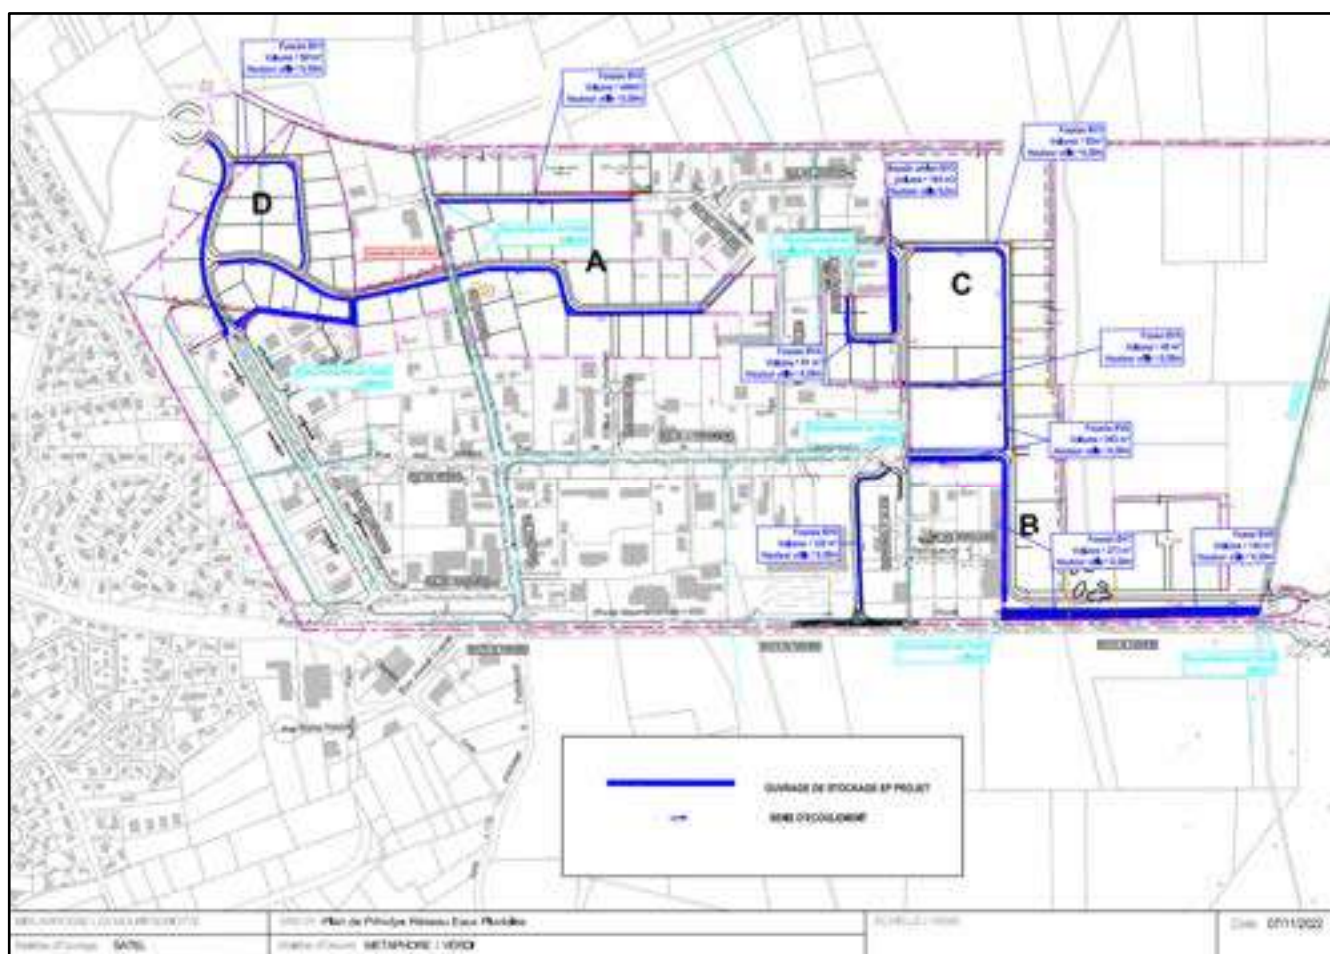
Plan de principe du réseau d'eaux pluviales (Source : VERDI)
